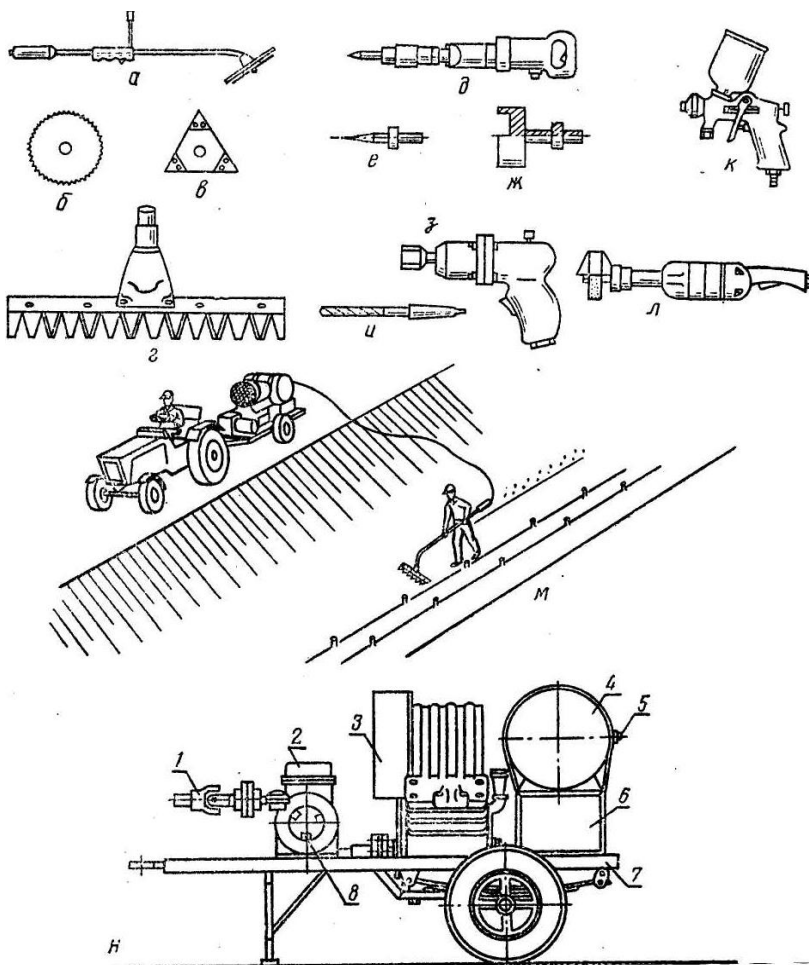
Комплектность и схема работы агрегата с пневматическим приводом механизированного инструмента: а – косилка; б, в, г – режущие насадки косилки; д – бетонолом; е, ж – наконечники бетонолома; з – пневмогайковерт; и – сверло; к – краскопульт; л – шлифовальная машина; м – схема работы; н – основной агрегат.
